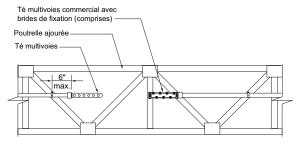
Support de tés multivoies sur des poutrelles de bois ajourées
